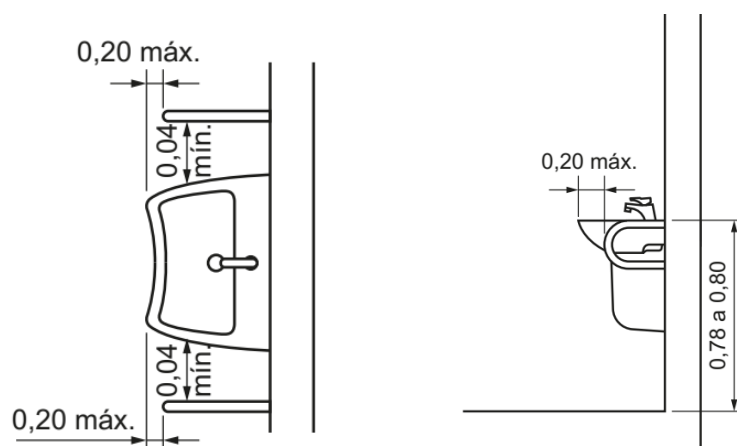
Instalação de barras de apoio nos lavatórios dos banheiros – Fonte: NBR 9050
